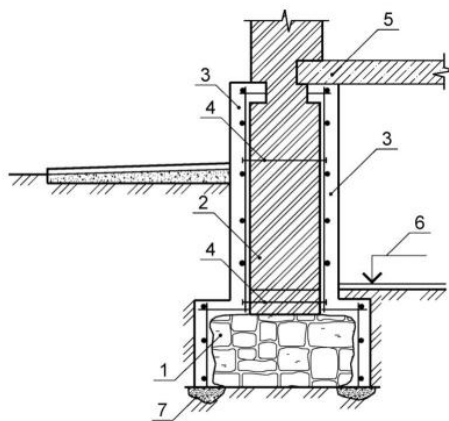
Увеличение несущей способности фундамента путем устройства железобетонных обойм: 1- усиливаемый бутовый фундамент; 2- усиливаемая кирпичная стена; 3- железобетонная обойма; 4- анкер; 5 – надподвальное перекрытие; 6 – отметка пола подвала; 7 – уплотненный грунт в основании конструкции усиления.[198]
